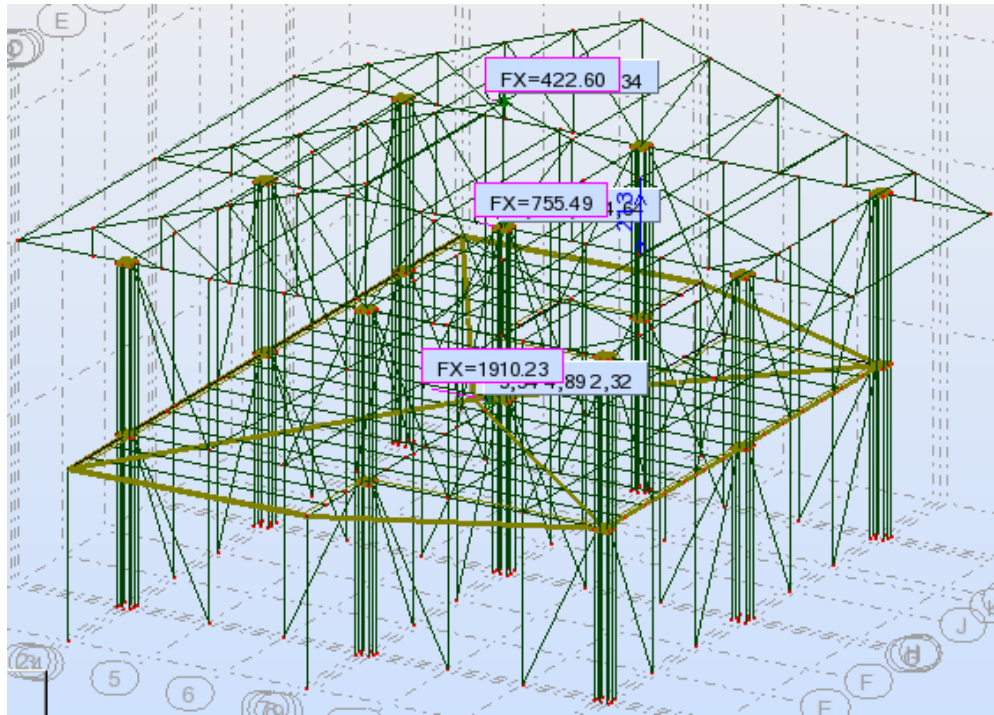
Aplicación de fuerzas basales (sentido x) en el centro de gravedad de las losas de la vivienda.
